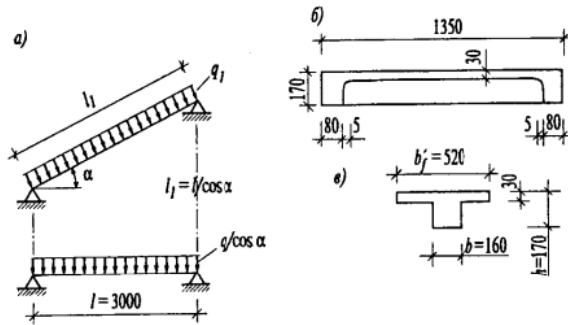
Розрахункова схема, реальне і преведений поперечий переріз.
